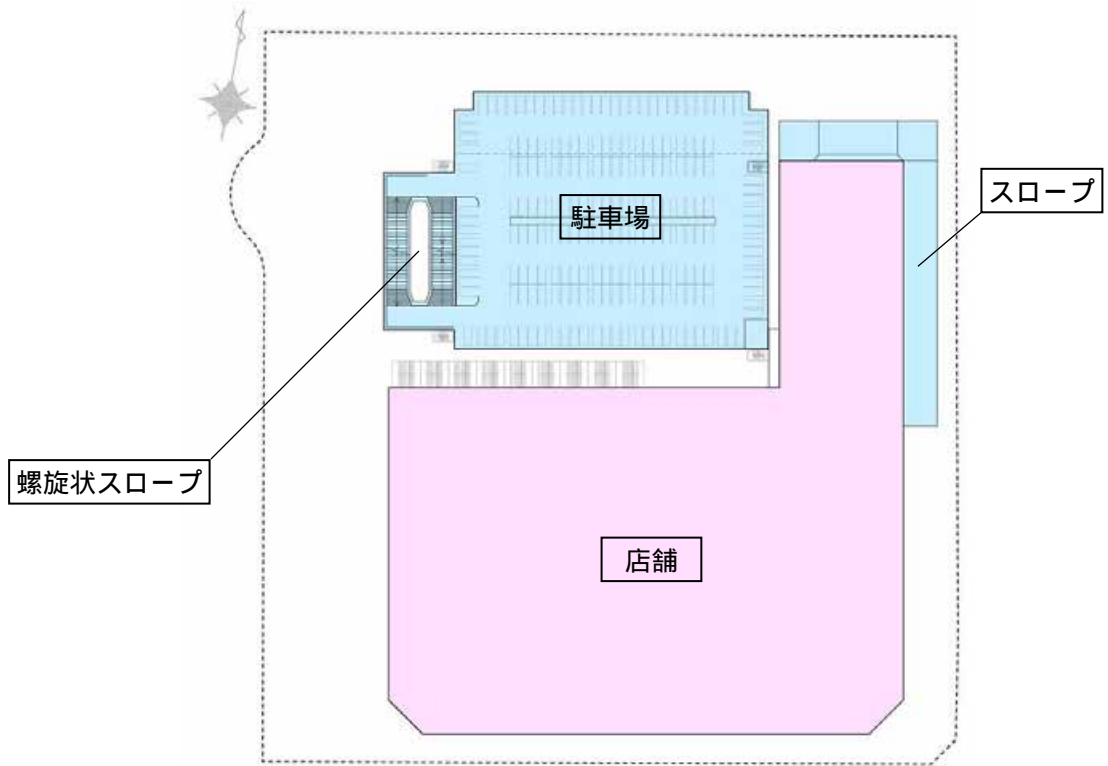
(2) 各階平面図(商業棟 2 階，駐車場棟 2～4 階)【評価書時】
